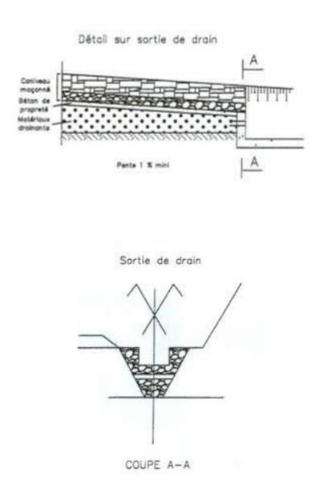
PROFIL EN TRAVERS DE DRAIN
